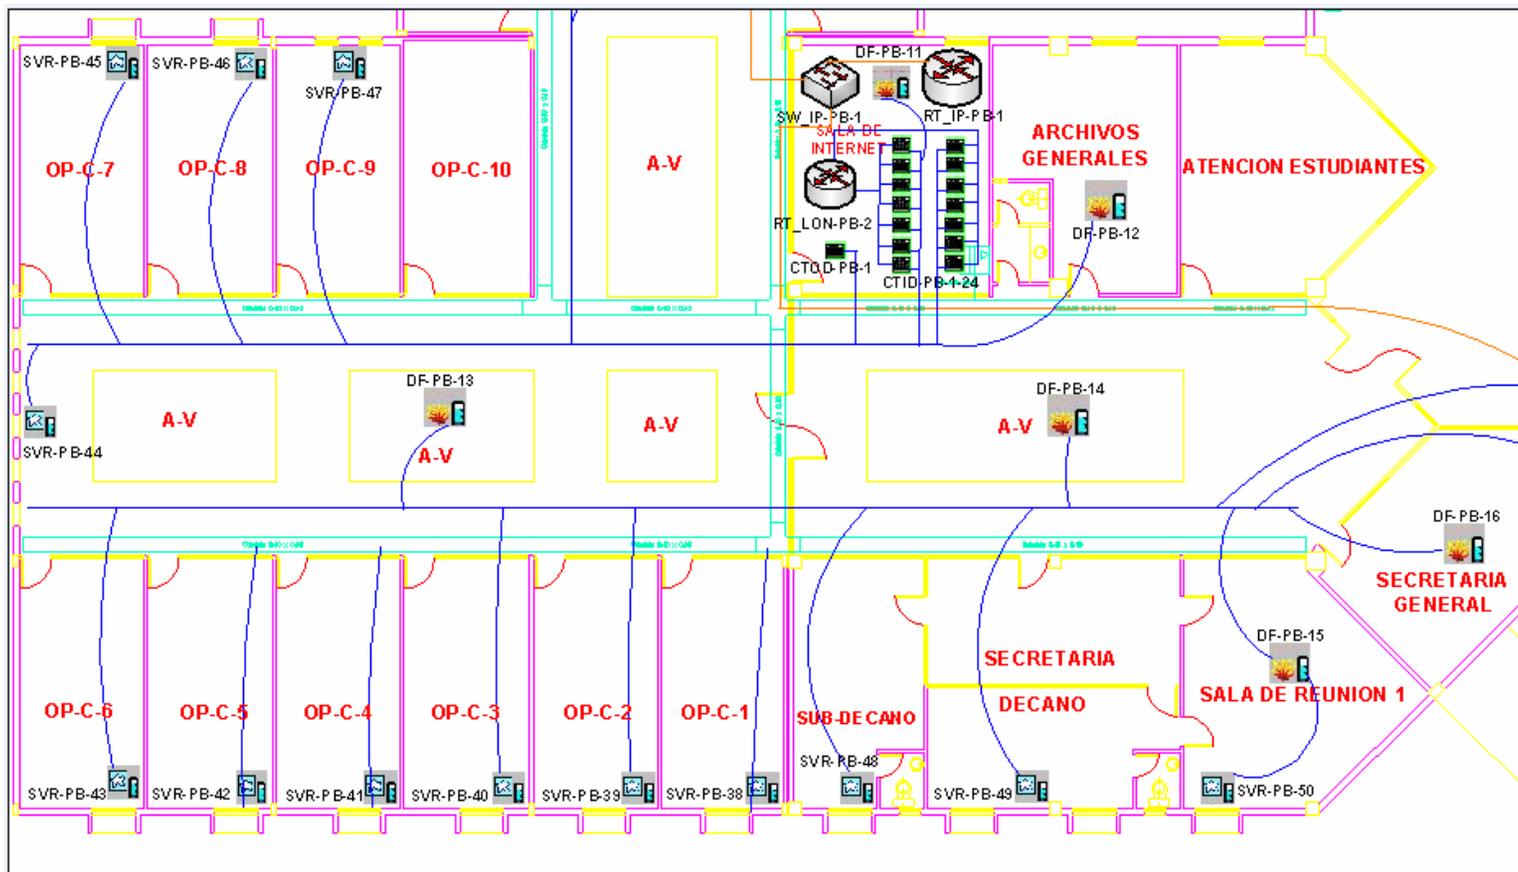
PLANO SEGURIDAD PLANTA BAJA SECCION 6
